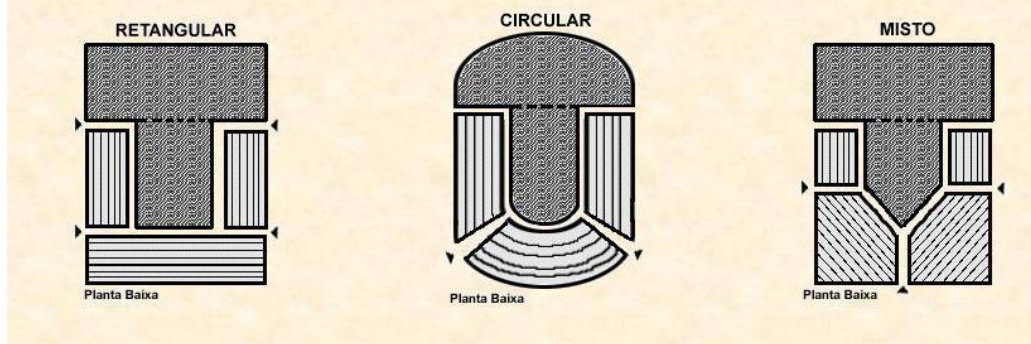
plantas baixas de tipos de palco Elisabetano.
